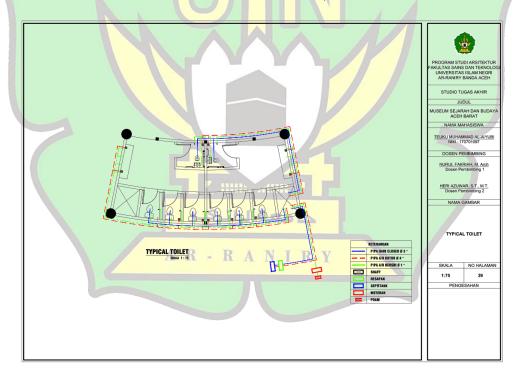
Denah Sanitasi Lantai 3 Sumber: Dokumen Pribadi, 2021
